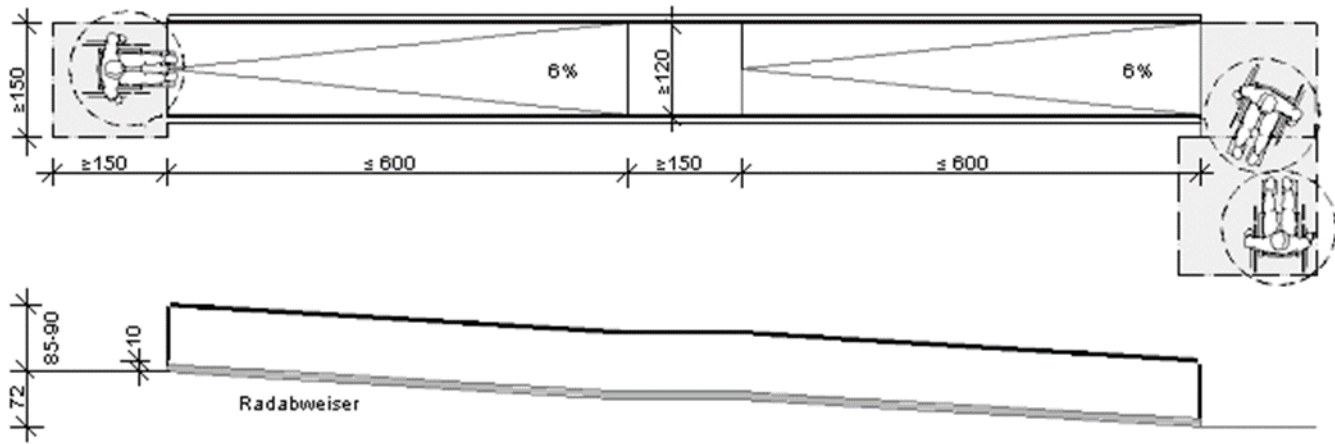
Grundriss (oben) und Längsschnitt (unten) mit Bemaßungen gemäß DIN 18040-1 [13]
